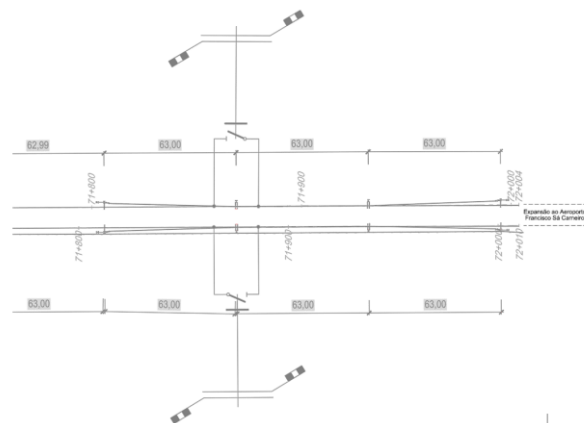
SLA para a separação elétrica com a futura expansão para o aeroporto
